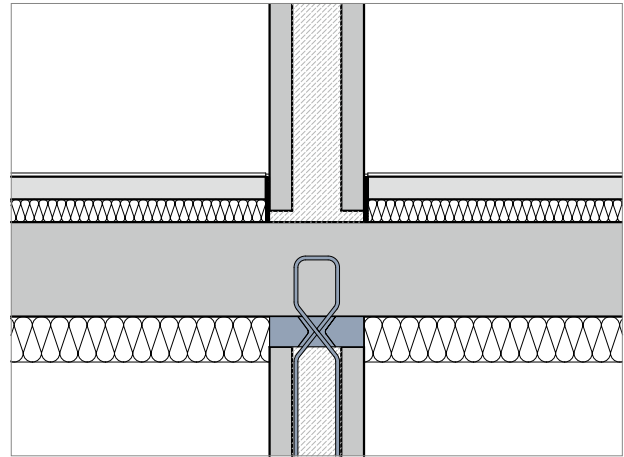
Schematische Darstellung Schöck Sconnex® Typ W bei Doppelwänden und Unterdeckendämmung
